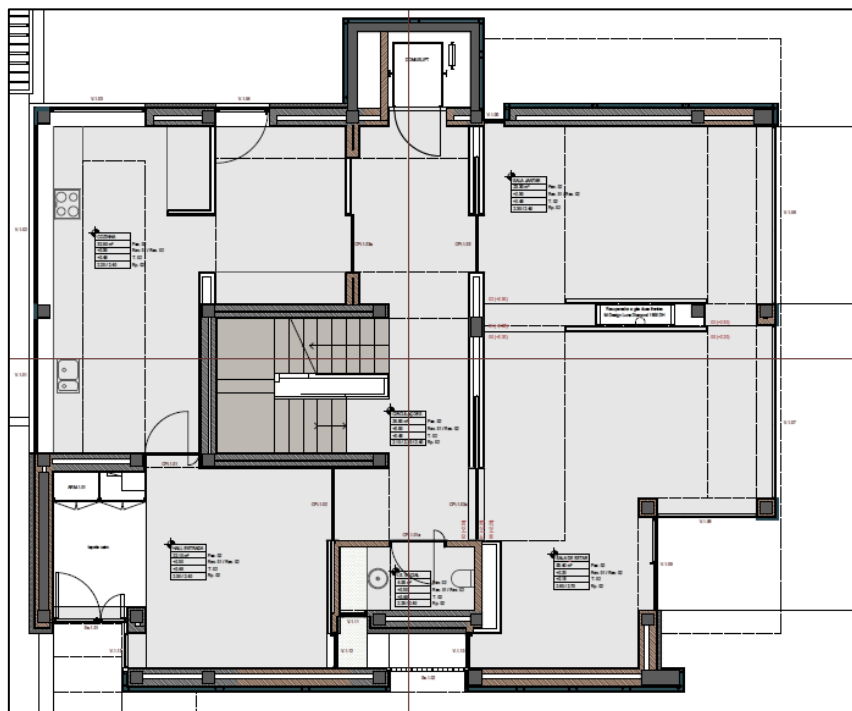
Planta do Caso de Estudo 1 – Habitação Unifamiliar – Remodelação
